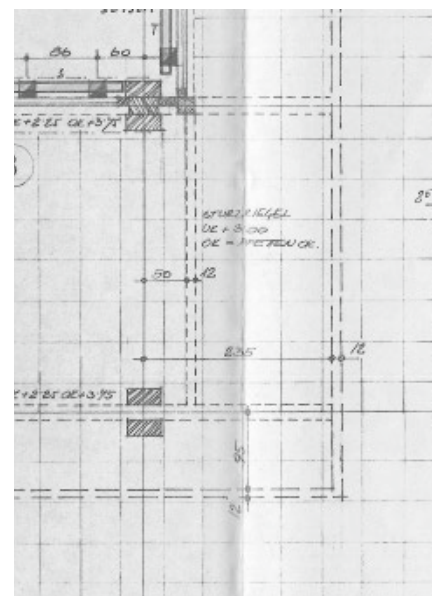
Ausschnitt Polierplan Obergeschoß 1977 mit kotiertem Dachüberstand
